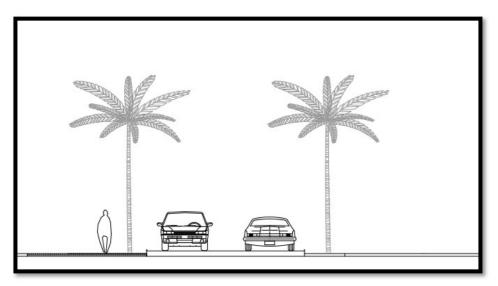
Sección transversal tramo 3. Fuente: Elaboración propia
